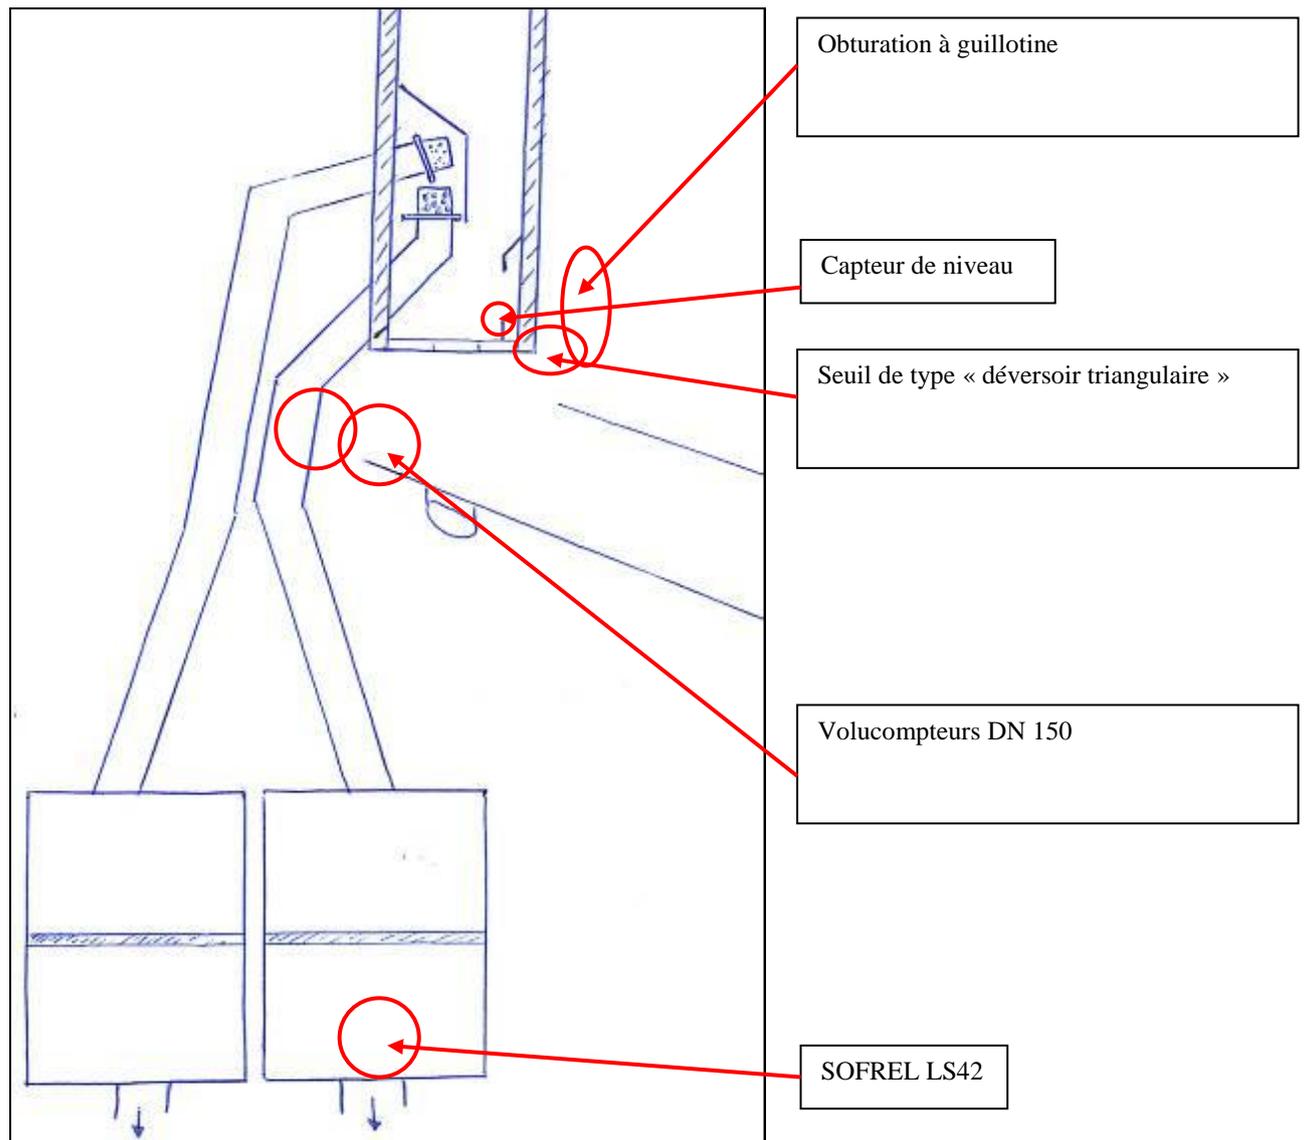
PLAN SCHEMATIQUE DE L'INSTALLATION DU CAPTAGE DE VERDUS
